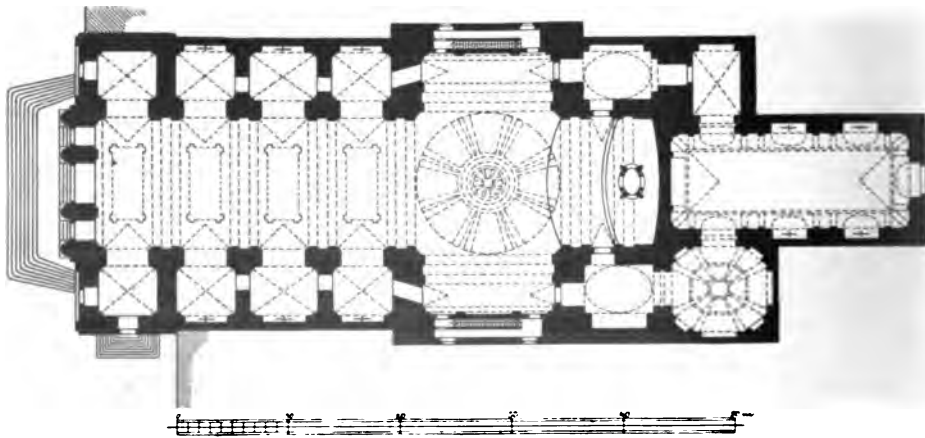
San Juan Bautista in Toledo Grundriß (Aufnahme des Verfassers)
